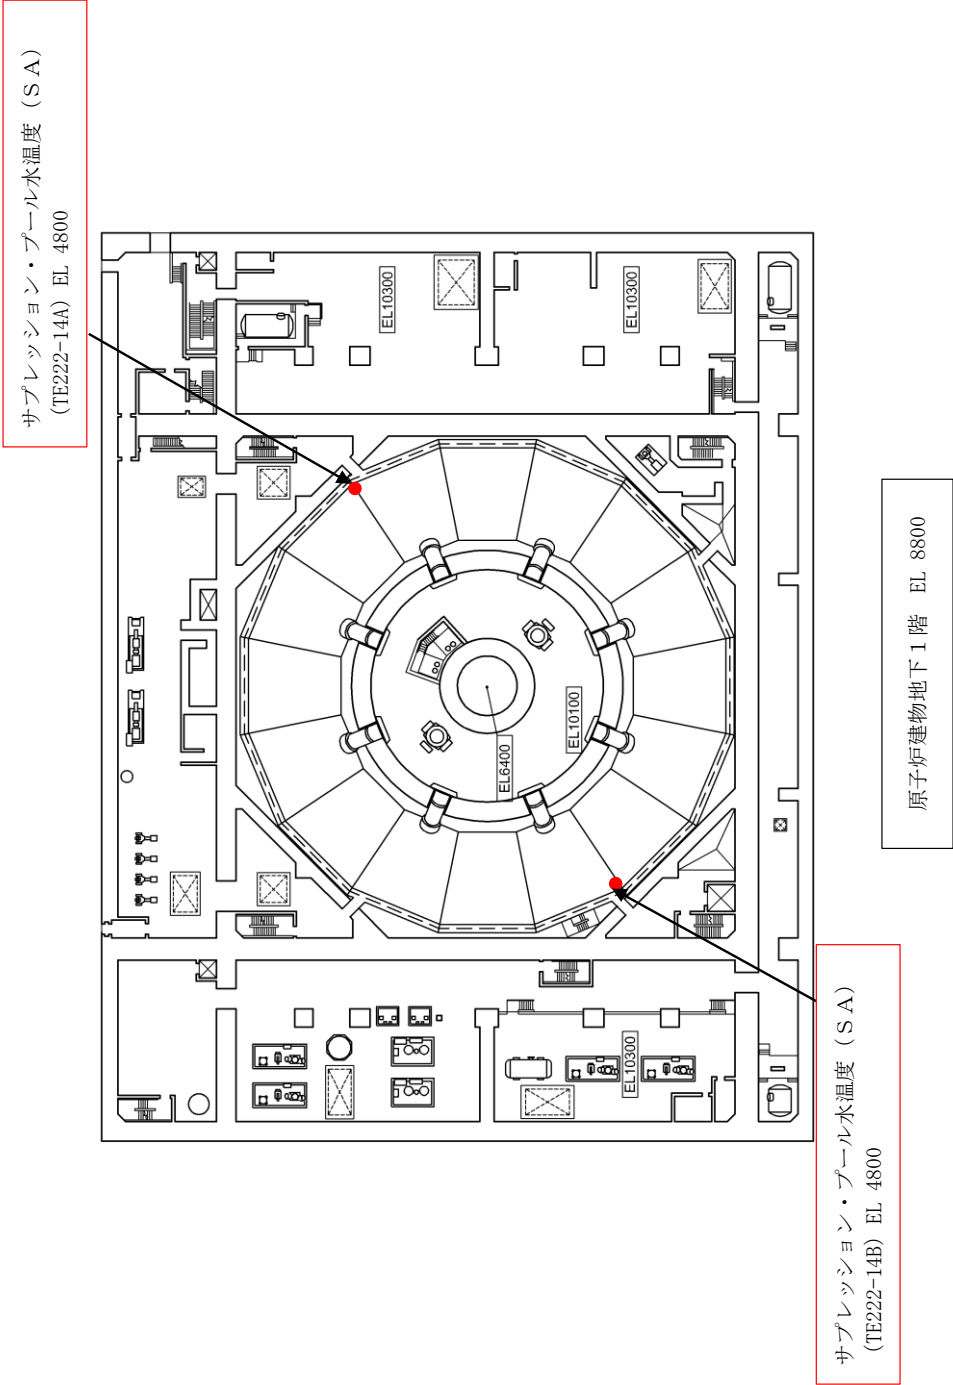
機器配置図 (原子炉建物地下1階)
